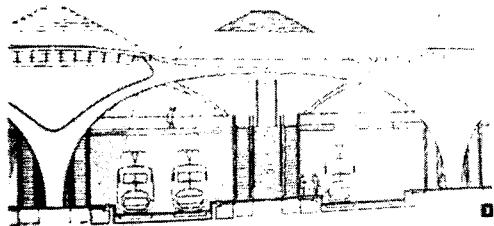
주간의 주광의 유입을 보여주는 Elevation section
